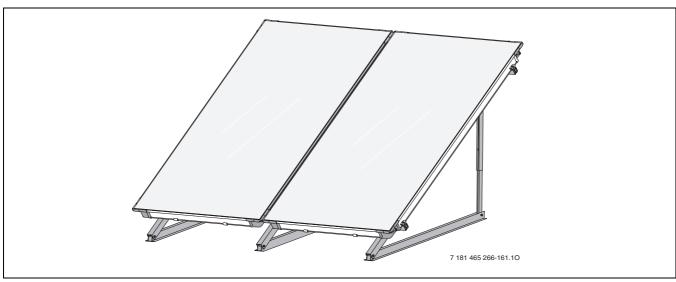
Flachdachmontage mit zwei Flachkollektoren FKC-1S
